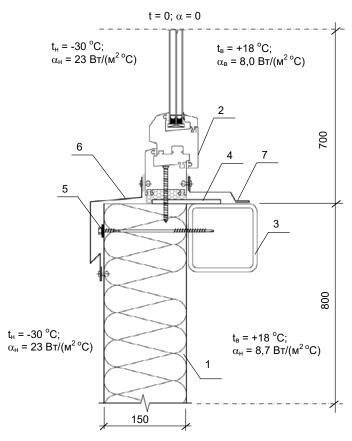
Расчетная схема узла сопряжения наружной стены с оконным блоком: 1 – стеновая панель; 2 – оконный блок; 3 – фахверковый ригель; 4 – стальная пластина для крепления оконного блока; 5 – элемент крепления стеновой панели; 6 - облицовка наружного откоса; 7 - облицовка внутреннего откоса
